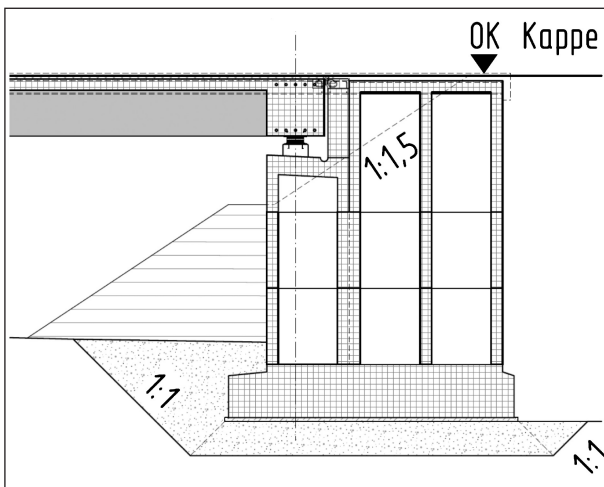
Schnitt, Stahlbetonhohlquerschnitt, aufgeständertes Widerlager
